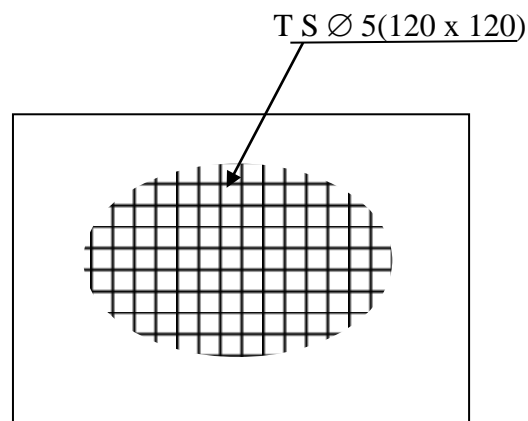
Schéma de ferrailage de Dalle de compression.
